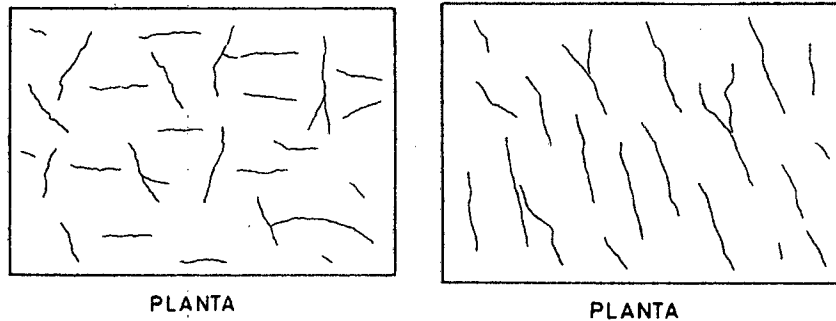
FISURAS NO ESTRUCTURALES POR RETRACCIÓN [Carlos Oyarzabal, 2008]
